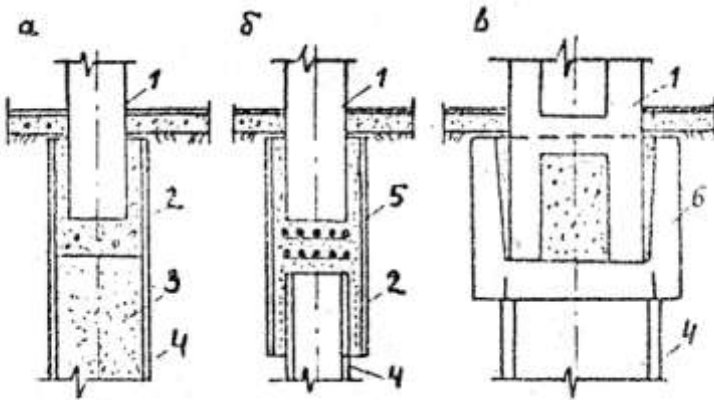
Сопряжение полый круглой сваи и сваи-оболочки с колонной:
